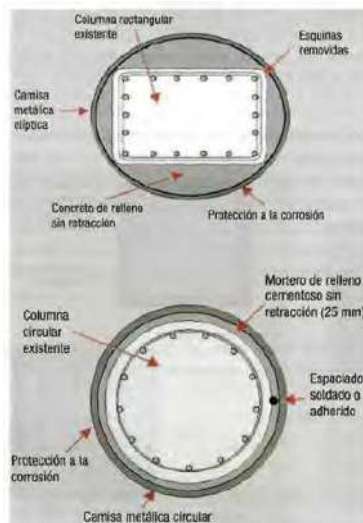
Encamisado en acero para cambiar de una columna rectangular a elíptica y encamisado de acero con una capa previa de concreto para uniformizar el elemento. (Rendón Ospina & Zambrano López, 2007)
